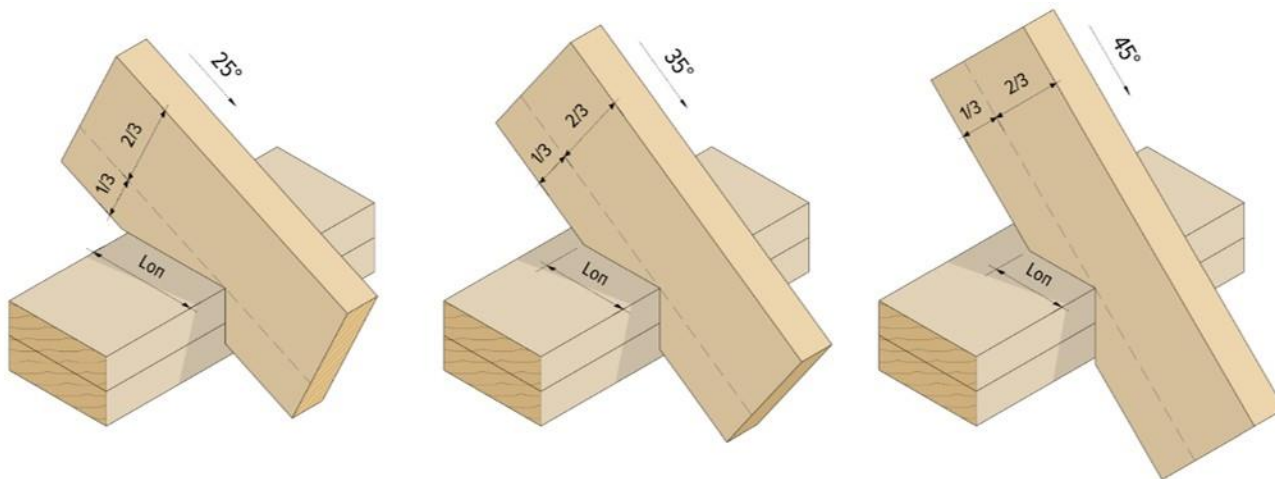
Глубина врезки в стропильную балку и длина опорной площадки  $L_{оп}$
